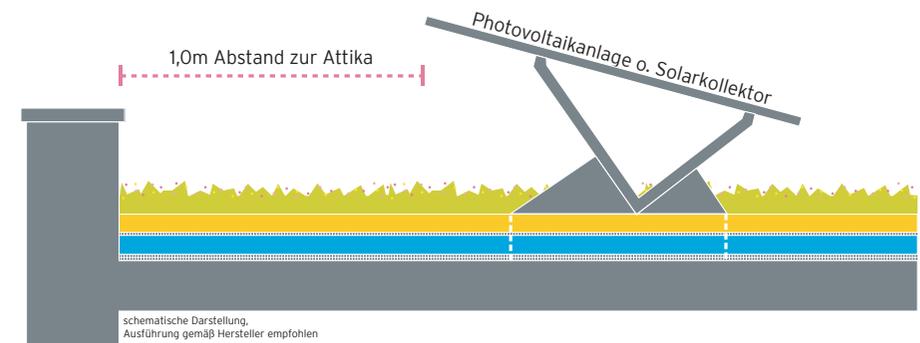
| Dachbegrünung und Technikfläche - Schema
